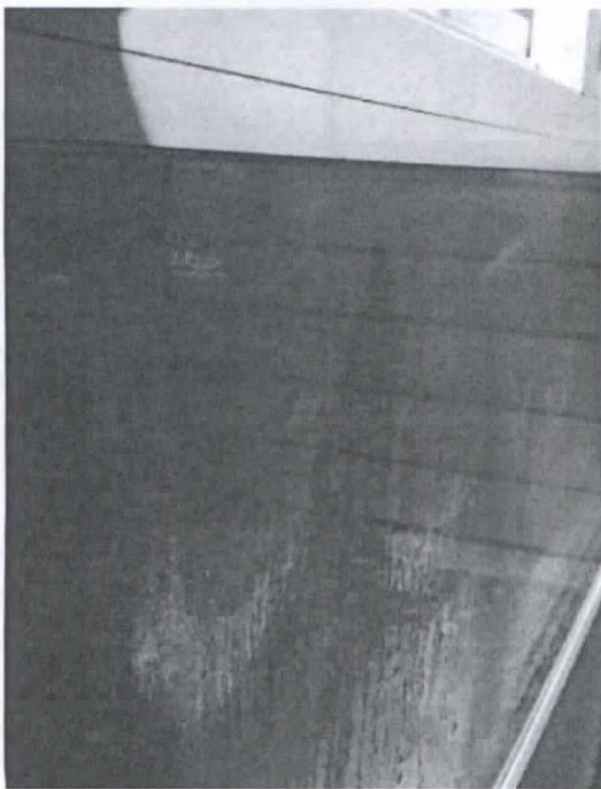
Revestimiento exterior de fibrocemento en la fachada poniente.
